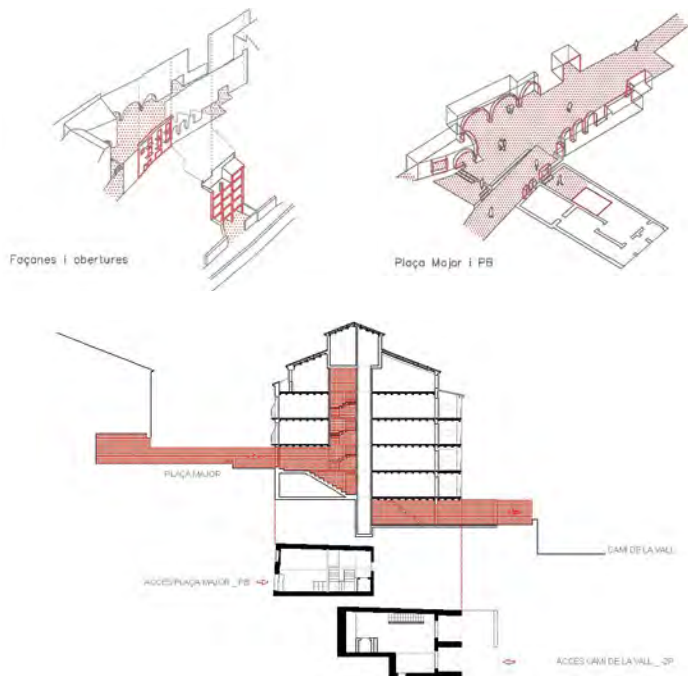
Arriba izq. Los dos planos verticales de fachada, en relación a la Plaza Mayor y a los huertos. Arriba der. El plano horizontal de la Plaza Mayor y el perímetro de porches y entradas que lo delimitan. Abajo: Sección longitudinal del proyecto de R.M.P. Dibujos del autor.
